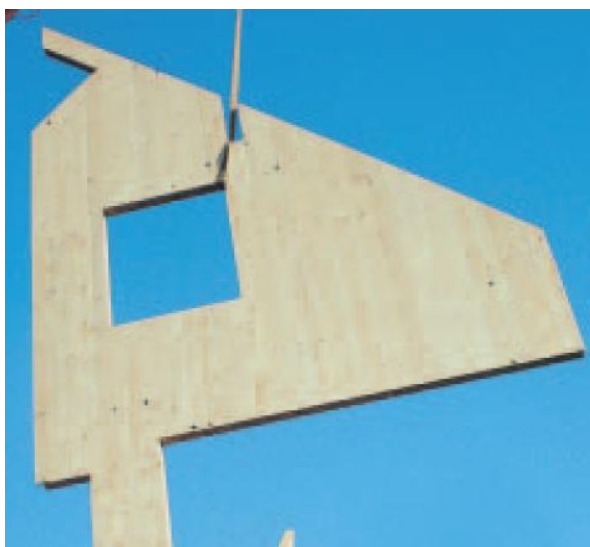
Imagens da construção e aplicação do material MEGAPLAN, em obra
